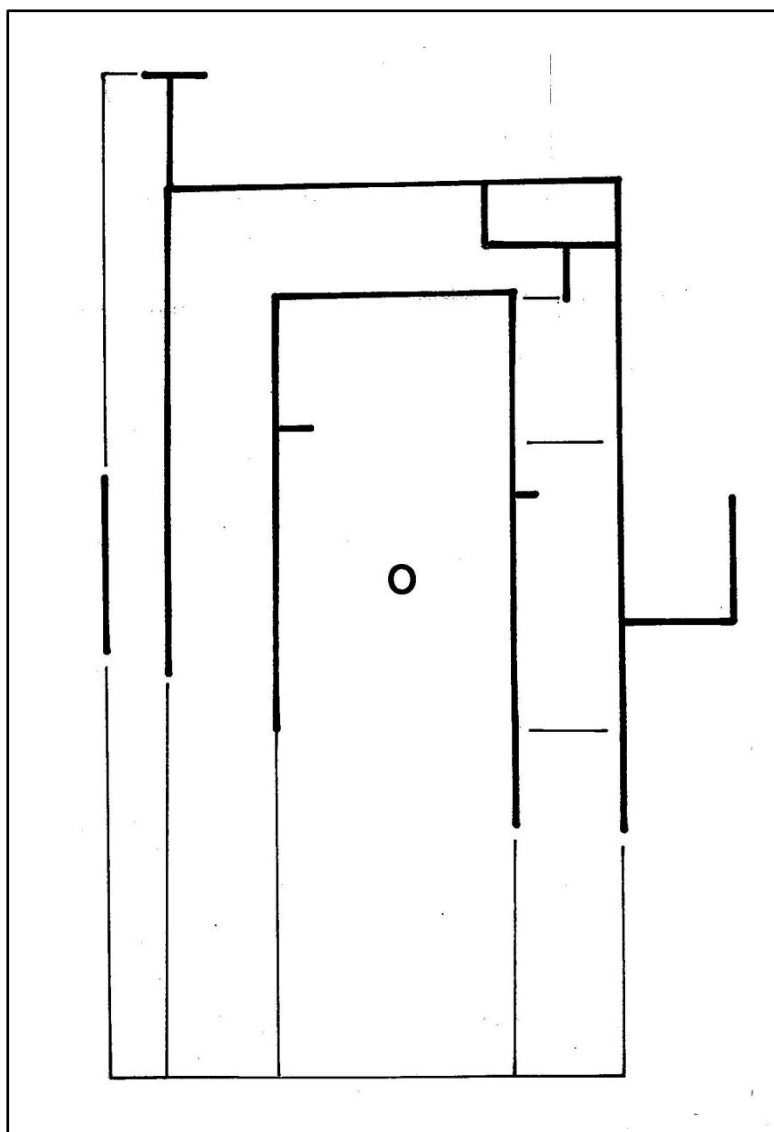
Schematische Grundriss des Gebäudes O der 3. Kastellphase, Maßstab 1:500.
